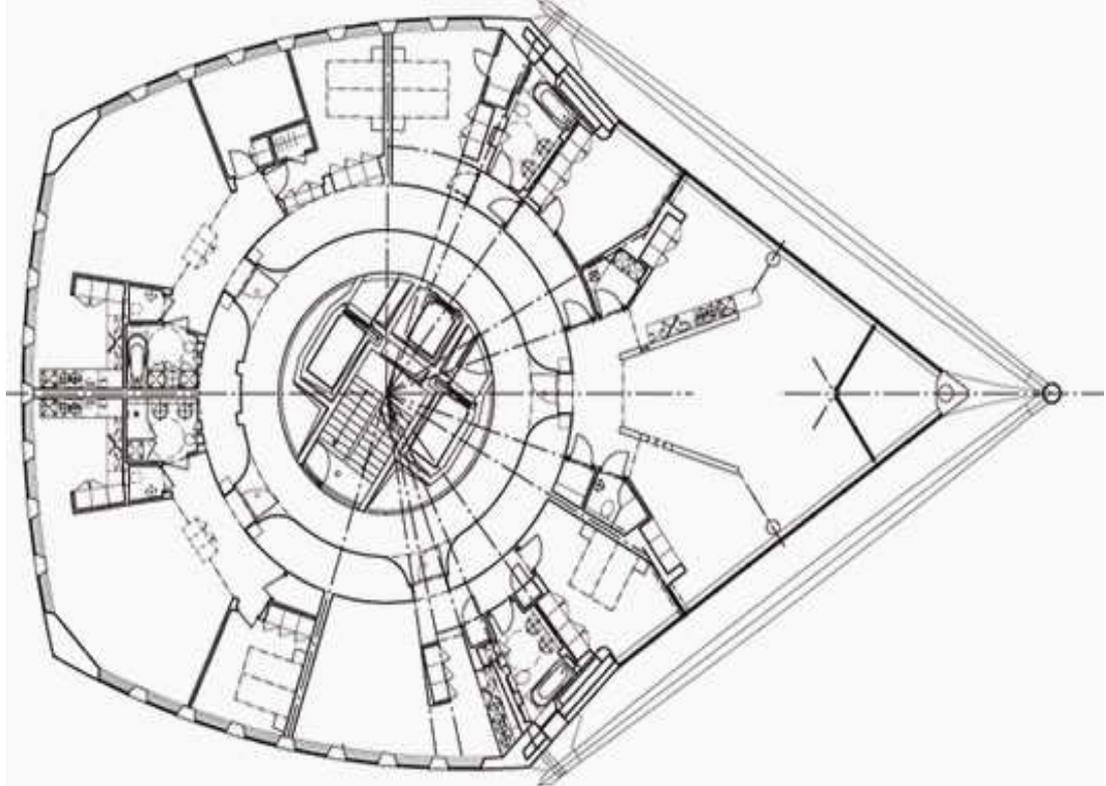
Planta arquitectónica, Turning torso, Suecia
